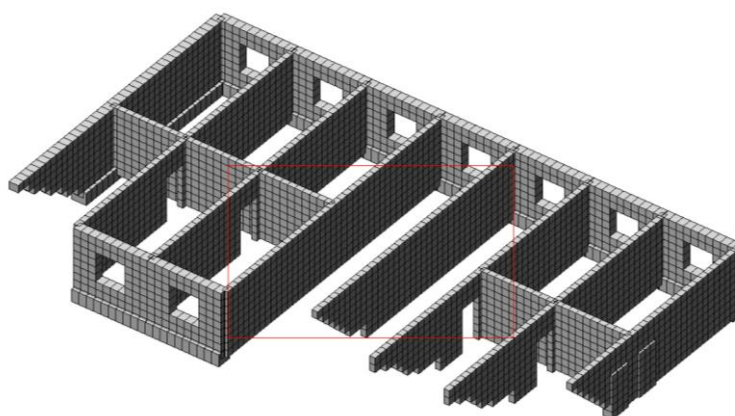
Схема этажа панельного здания с разрушенными стенами
